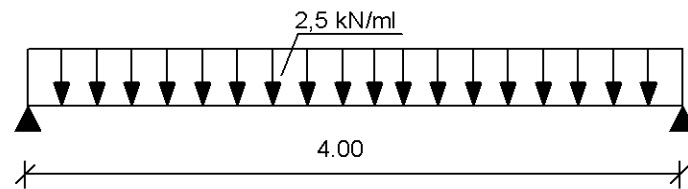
Schéma statique de la poutre reposant sur 2 appuis
